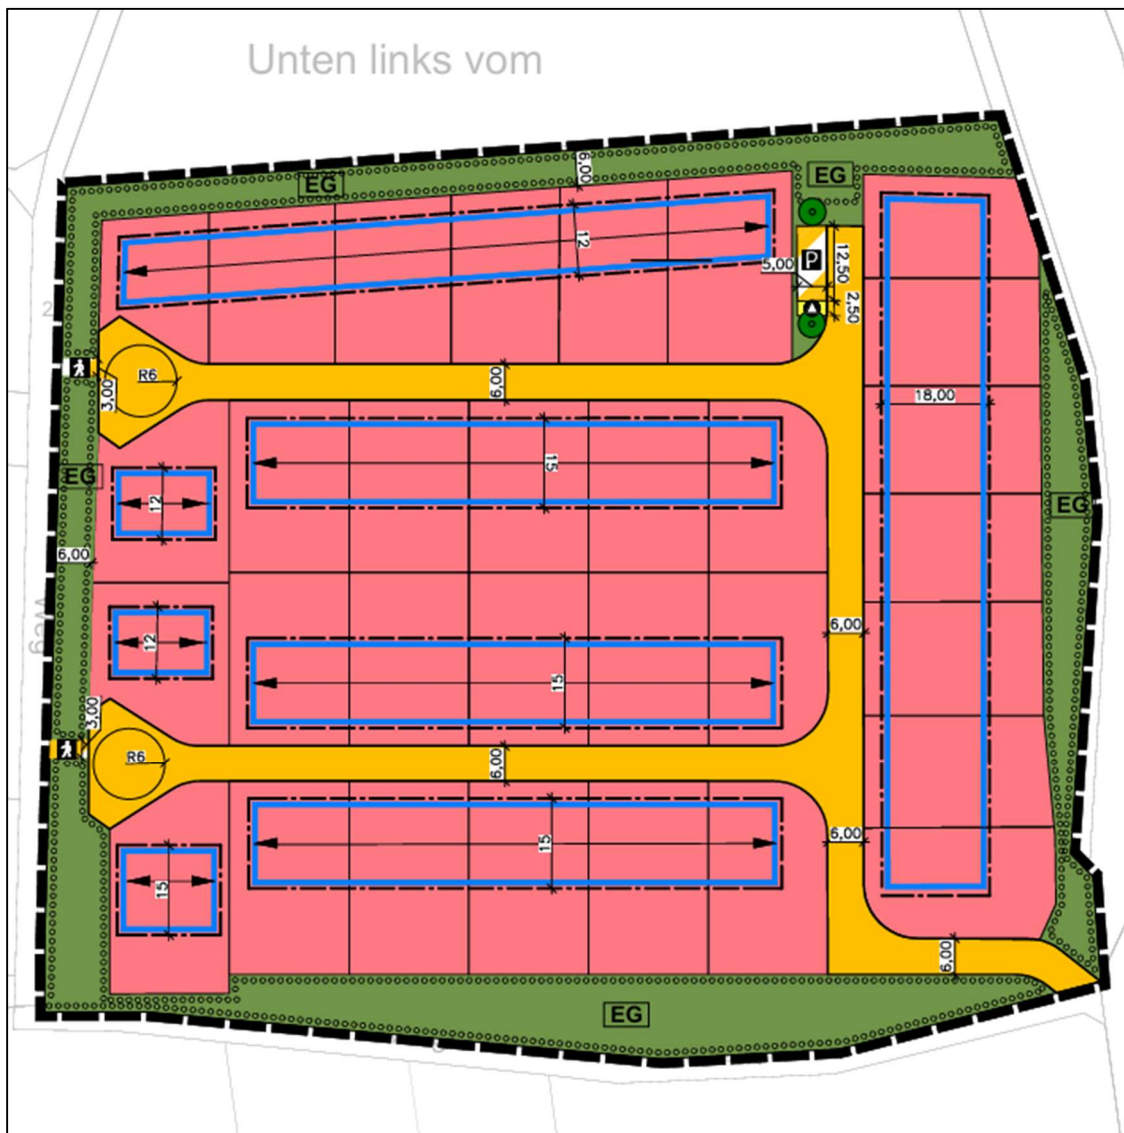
Bebauungsplan, Vorentwurf Maßstab 1:1.000
